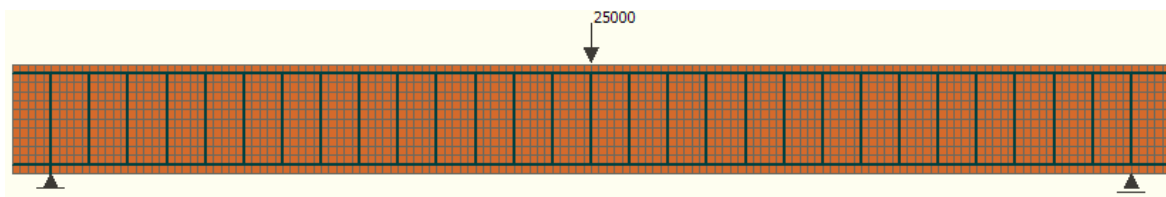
Viga biapoada discretizada em 1800 elementos finitos com armaduras longitudinais e transversais
